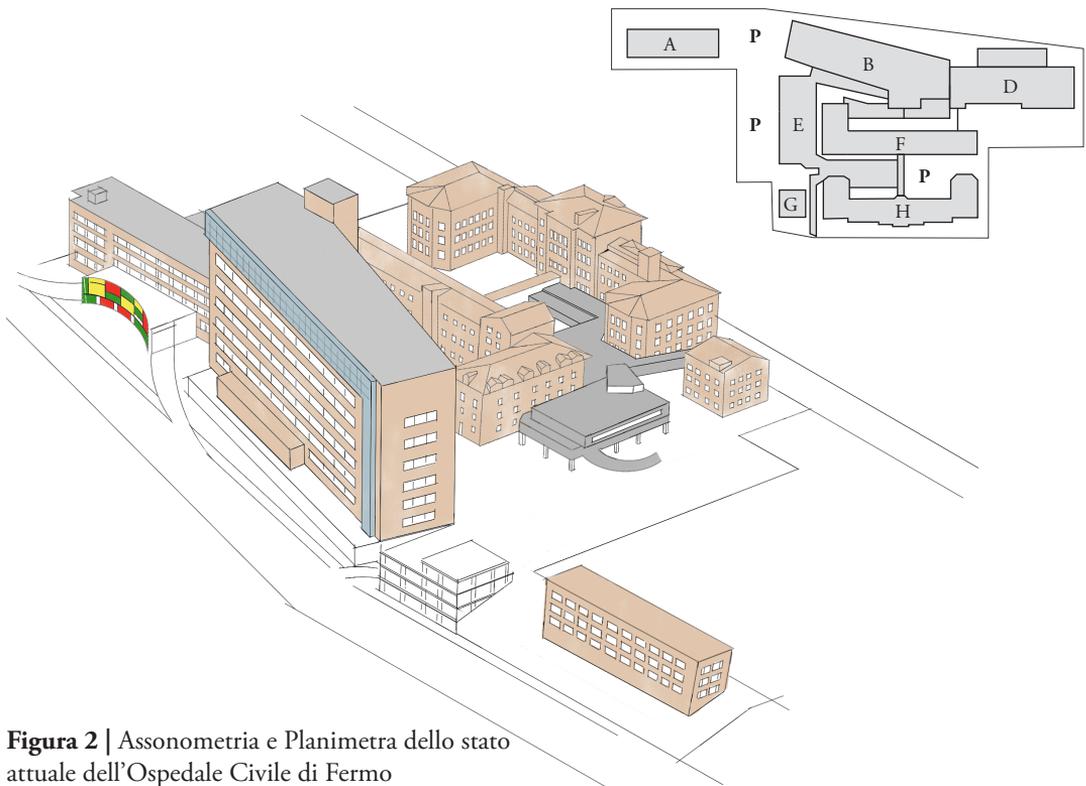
| Assonometria e Planimetra dello stato attuale dell'Ospedale Civile di Fermo
